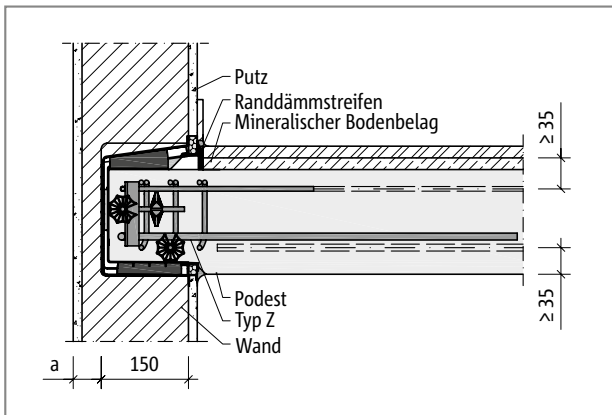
Schöck Tronsole® Typ Z: Brandschutzausführung
